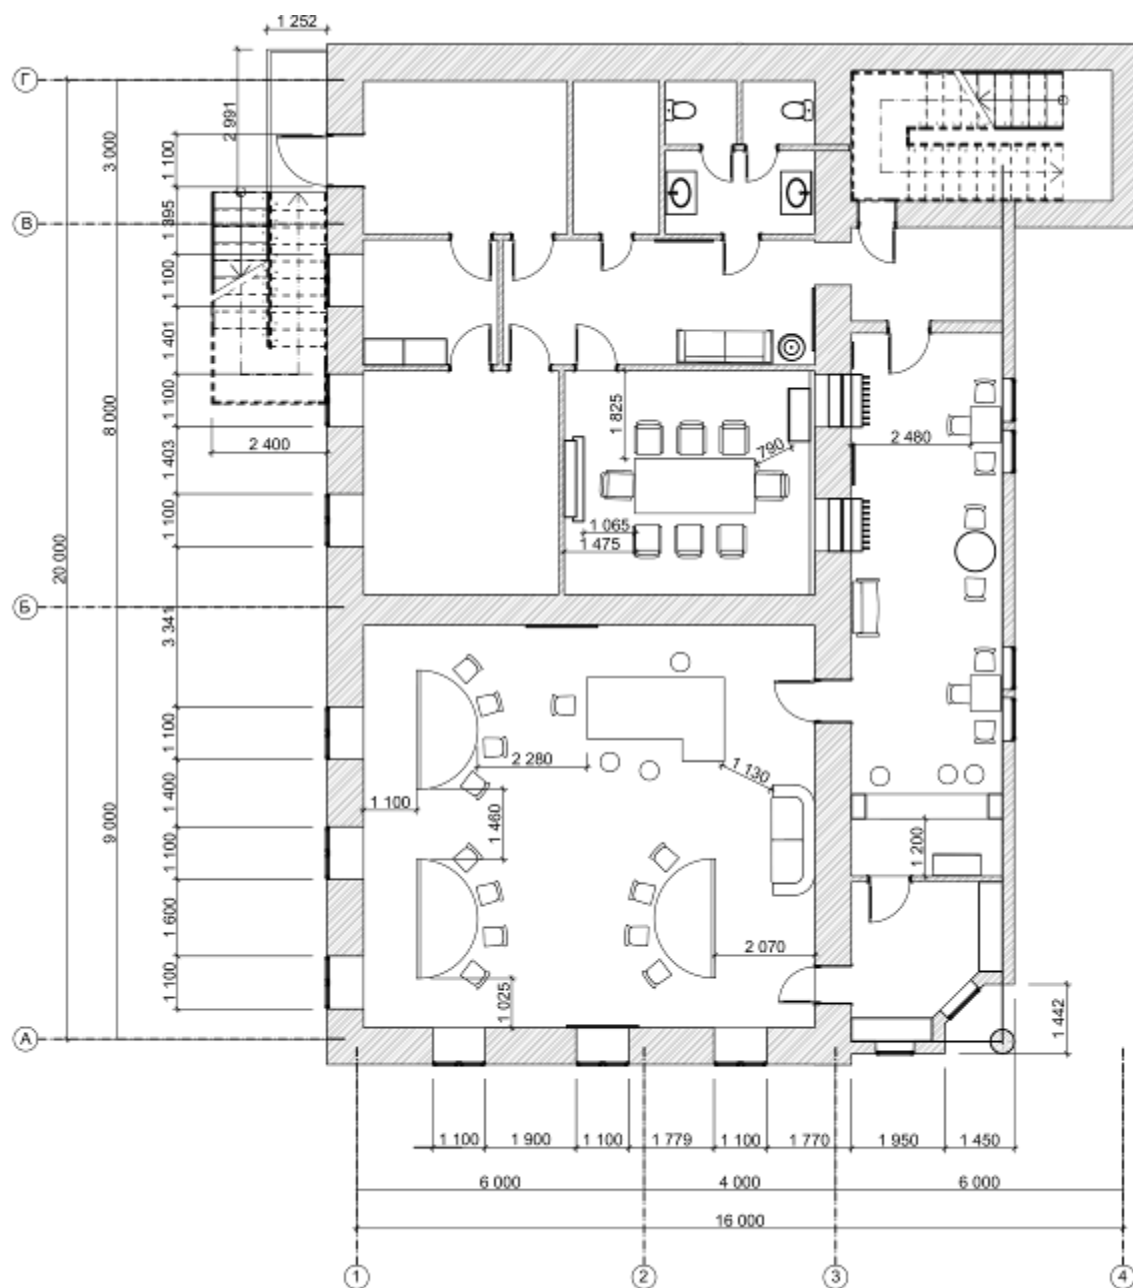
План 2 этажа с расстановкой оборудования
